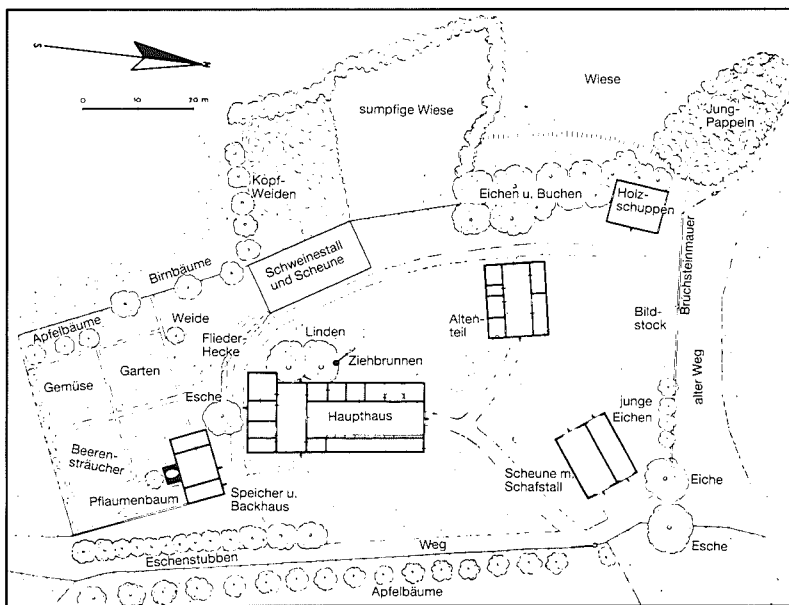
Lageplan eines typischen Bauerngehöftes im Delbrücker Land. Hof Barbrock in Anreppen/Heddinghausen
